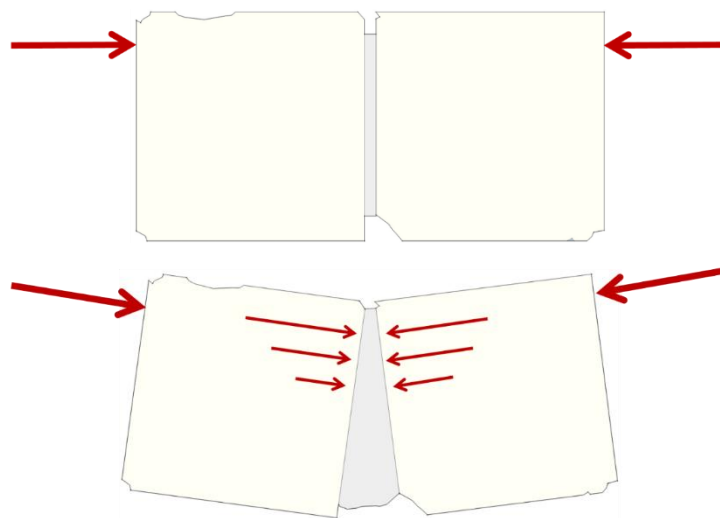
rupture par excès de compression de la pierre et rotation autour de l'arête d'un joint (Auteur, 2017)
